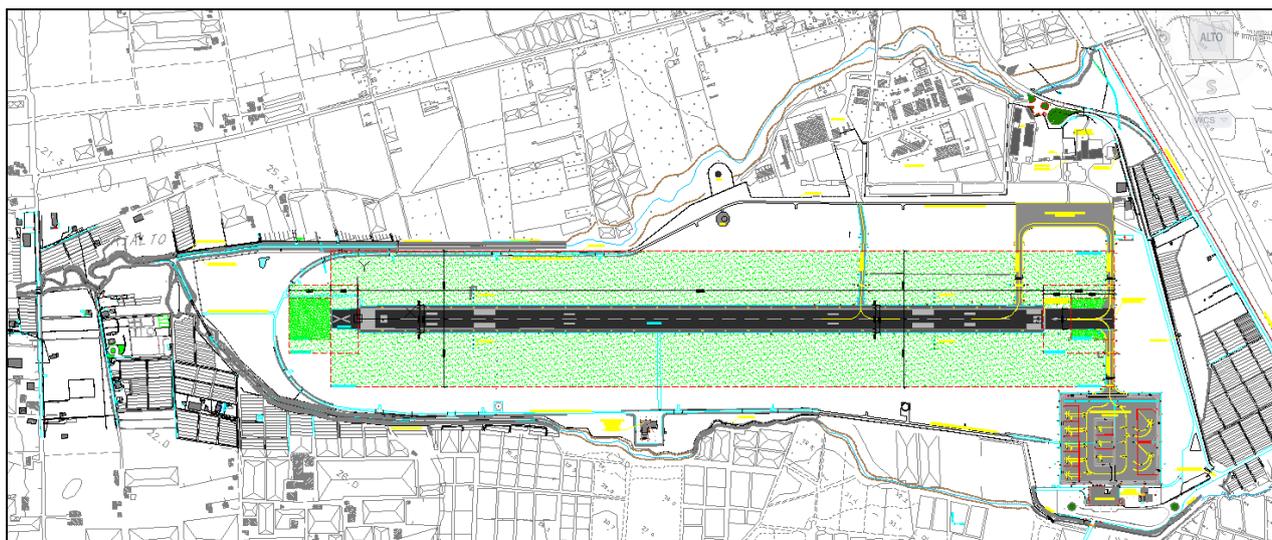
Layout delle infrastrutture di volo – Stato Attuale
